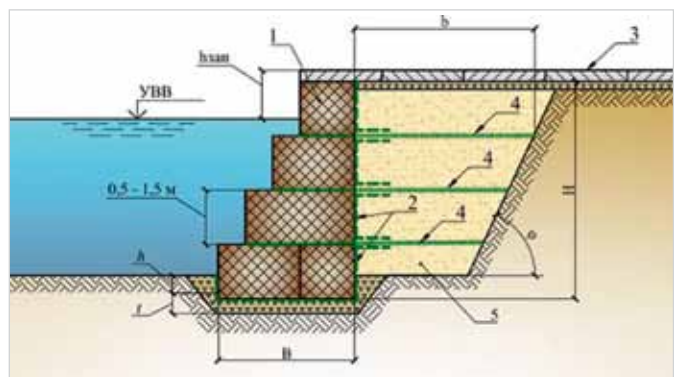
Укрепление размываемого берега реки с помощью габионных конструкций RockBox с армированием грунта
